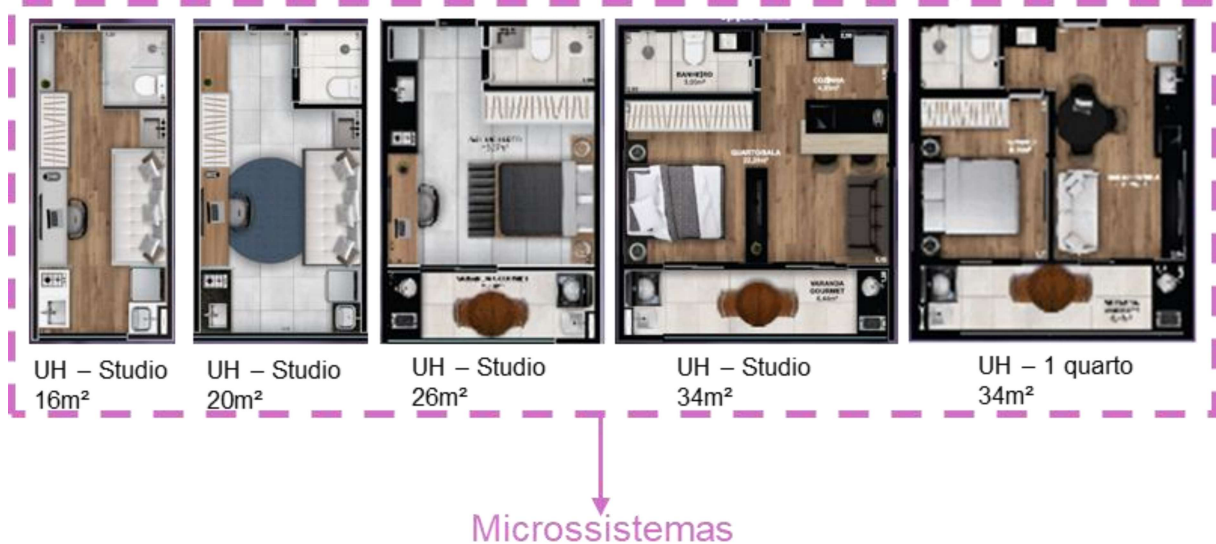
Plantas Baixas Humanizadas “empreendimento B” (sem escala).
